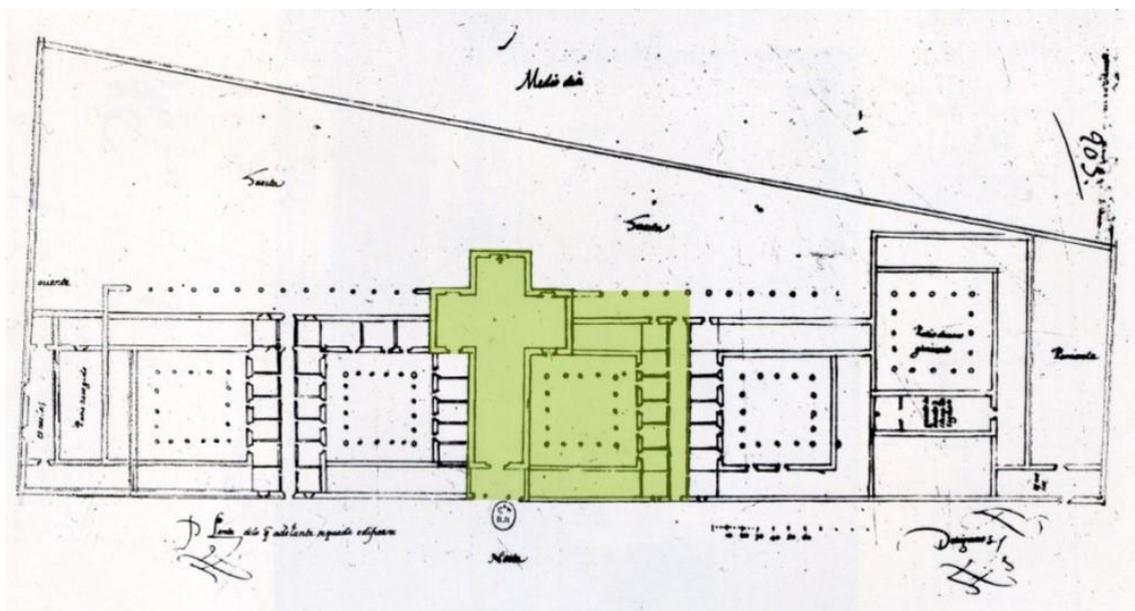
Planta del Proyecto* –en verde lo construido-. Fuente: M. Pulido Rodríguez [en adelante: MPR], (TIFM).
